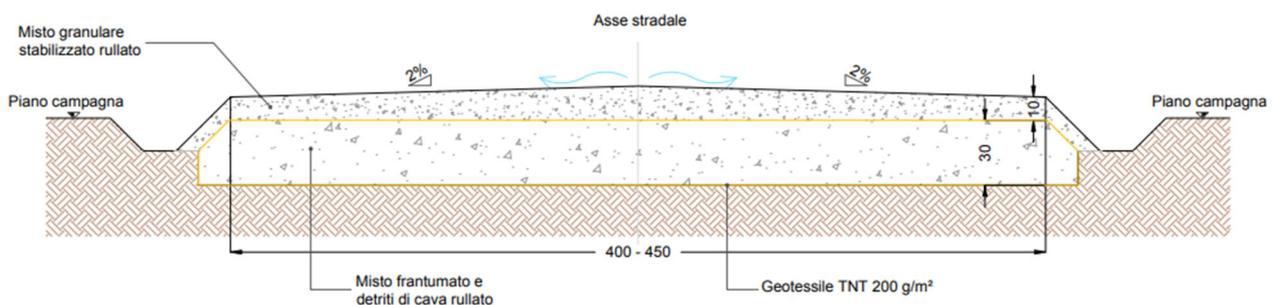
Sezione tipo pista di impianto; misure in centimetri
